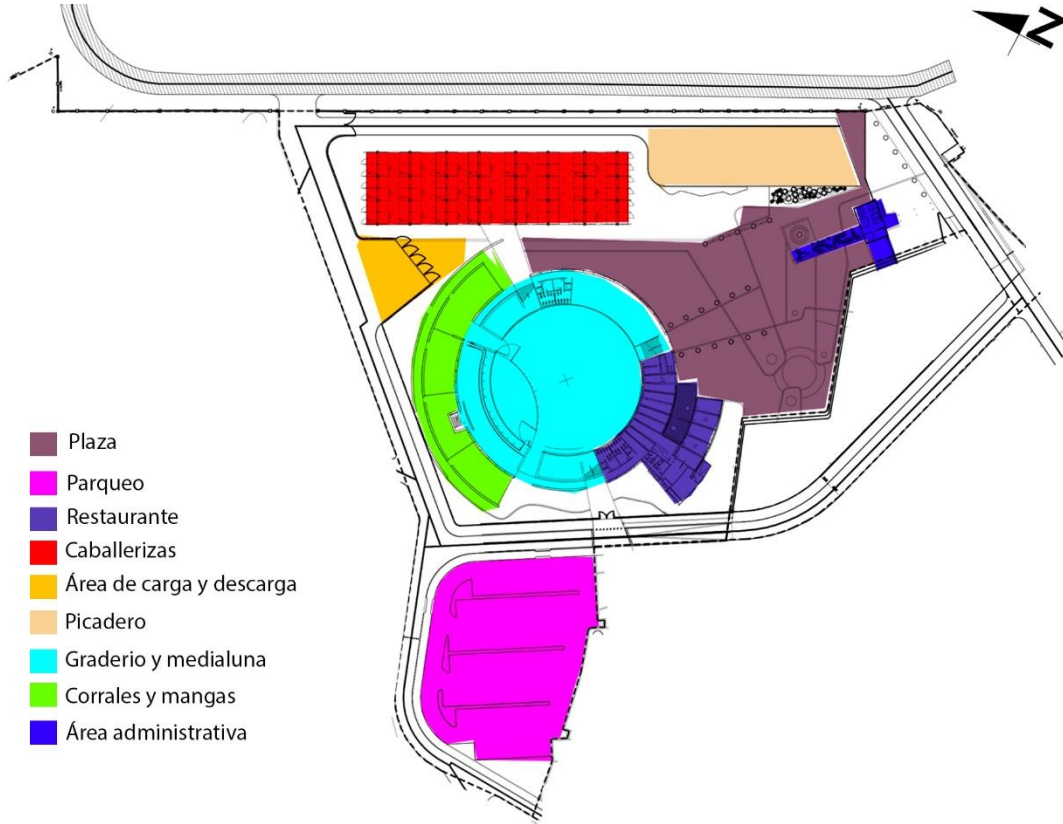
Análisis de áreas en planta de conjunto, extraído de plano original propiedad de Arqdesign
